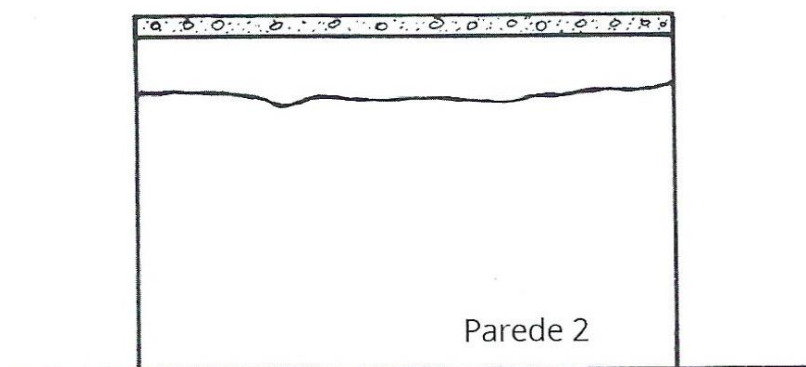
Fissura paralela ao comprimento da laje, em forma de escama
